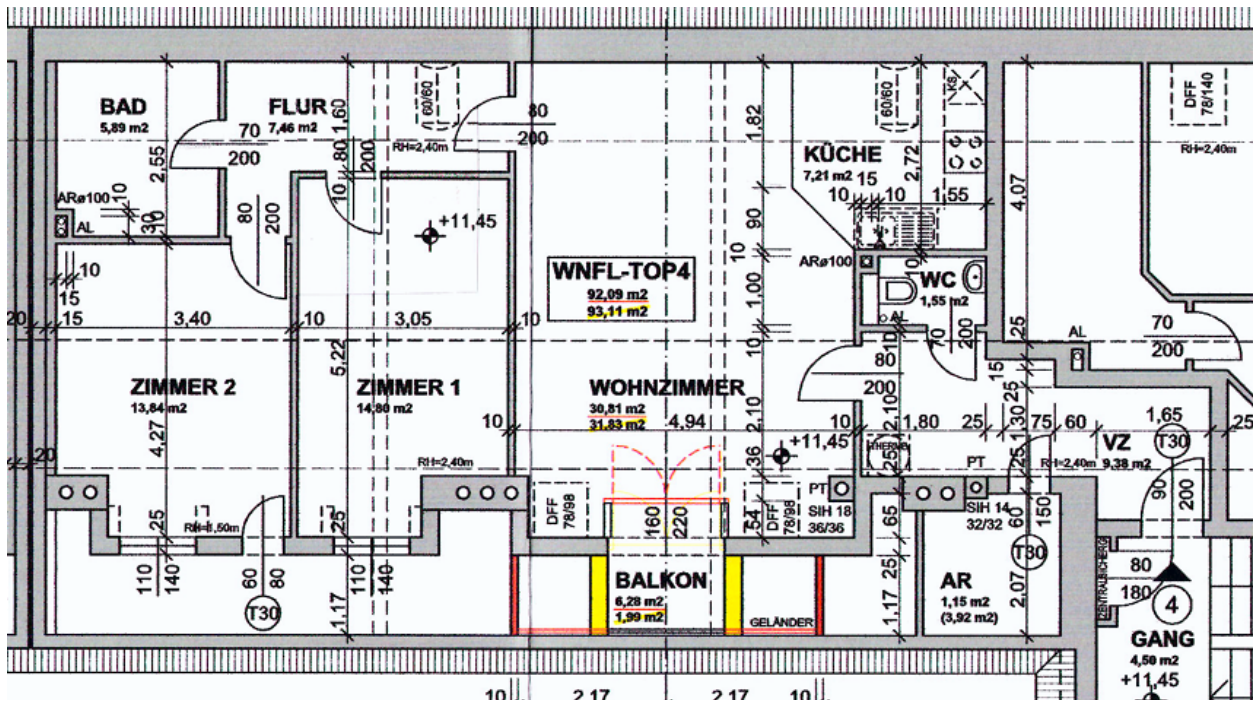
Grundriss Wohnung Top D 4 (Einreichplan 17.05.2005)
